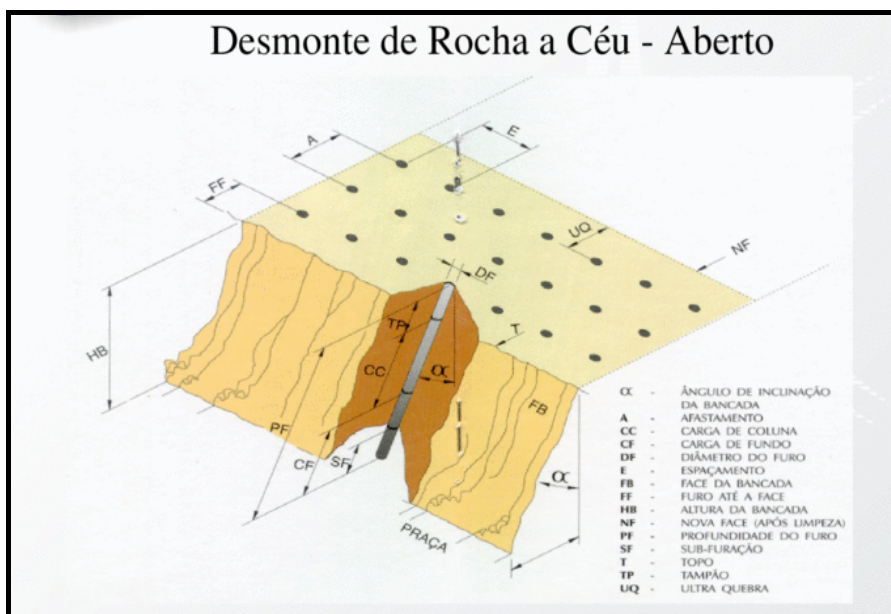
Elementos do plano de fogo de uma detonação - fonte internet acessado em 05/12/2016.
